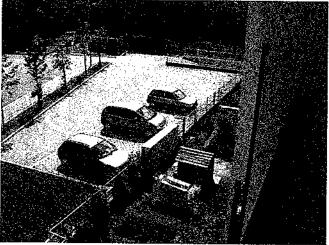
Panoramica dello stato di fatto attuale del cantiere.
